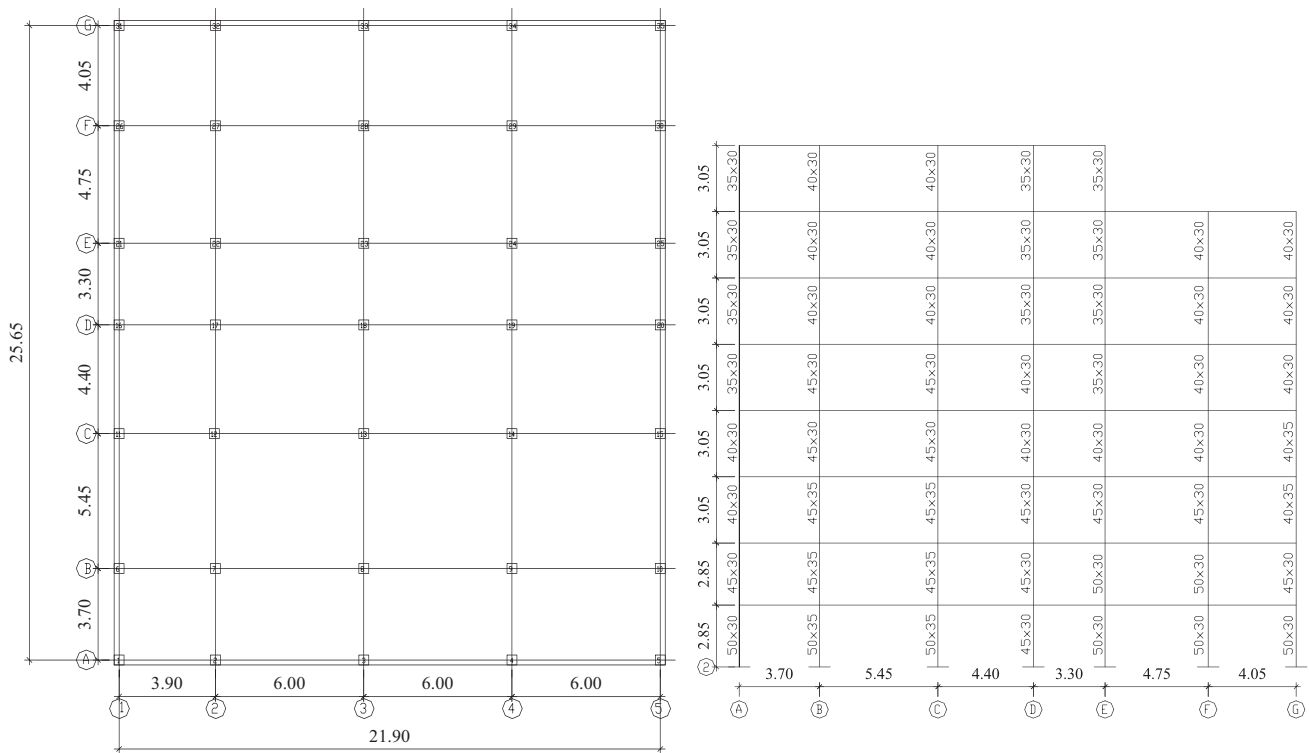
Planta de los edificios estudiados. 1a) Planta edificios RCH, RCM, RCL. 1b) Alzado pórtico 2 del edificio RCH.
